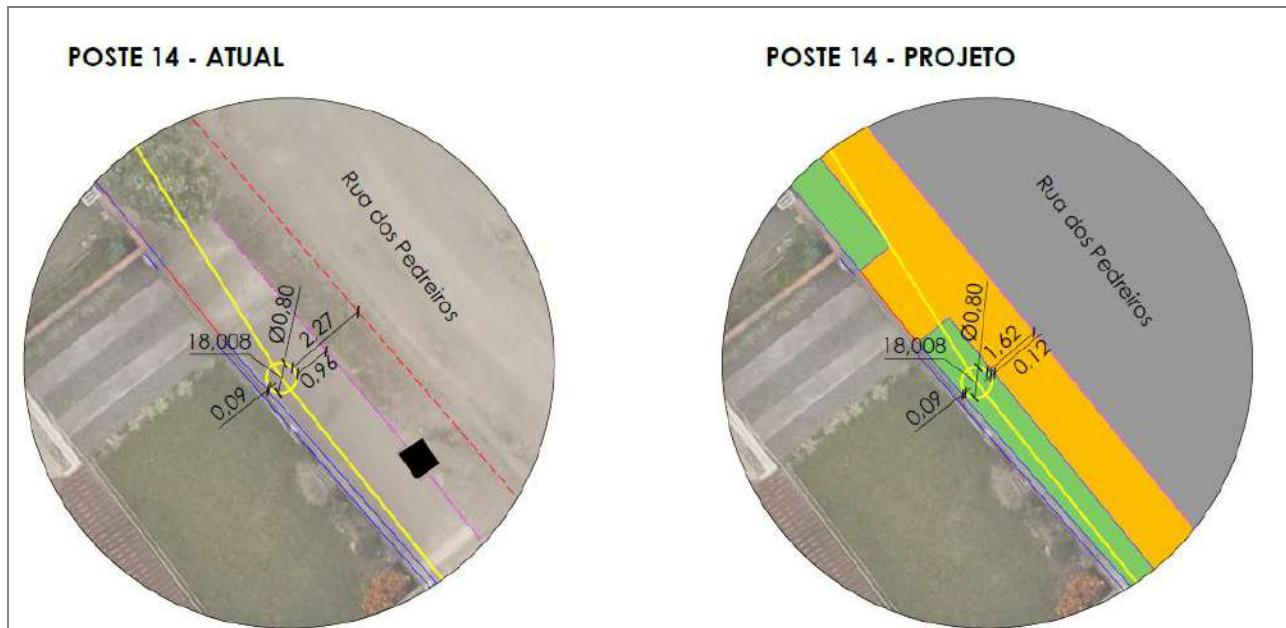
Exemplo de estrutura instalada em canteiro próximo ao muro. Fonte: Planta de locação dos postes.
